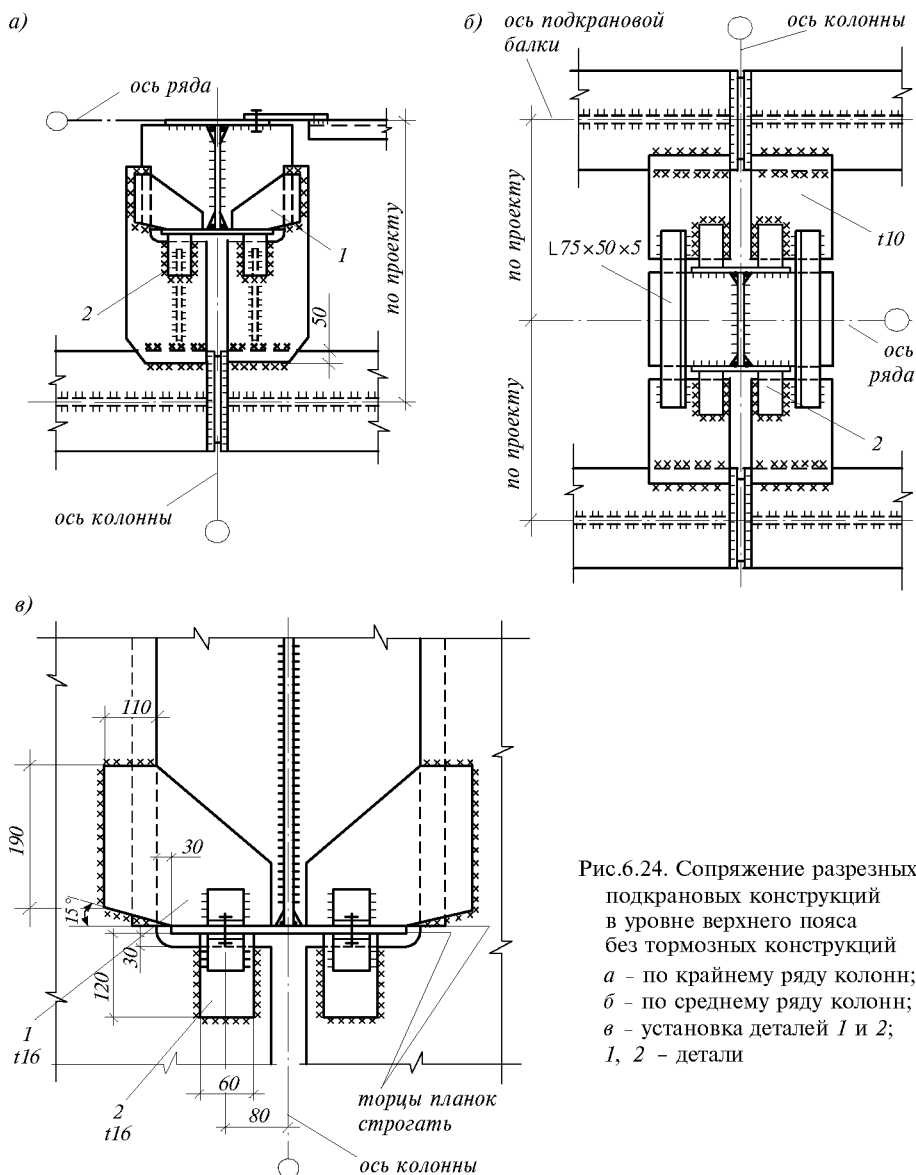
Сопряжение разрезных подкрановых конструкций в уровне верхнего пояса без тормозных конструкций
